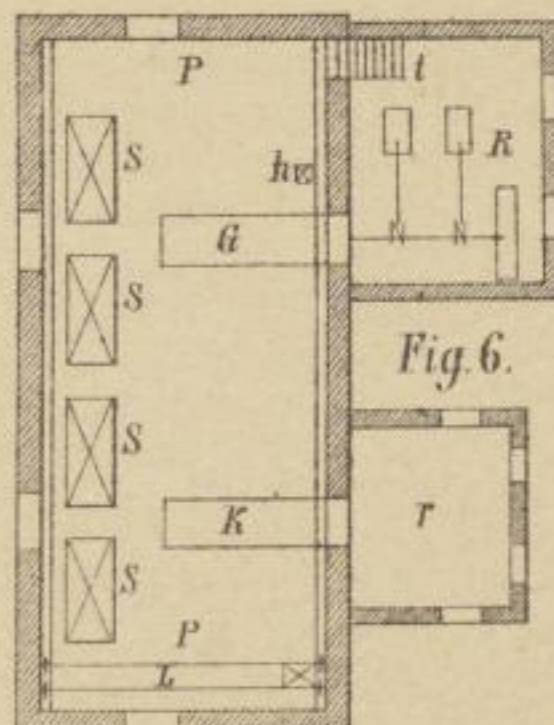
giebt den Plan des Hauptwalzwerkes. Es sind:
